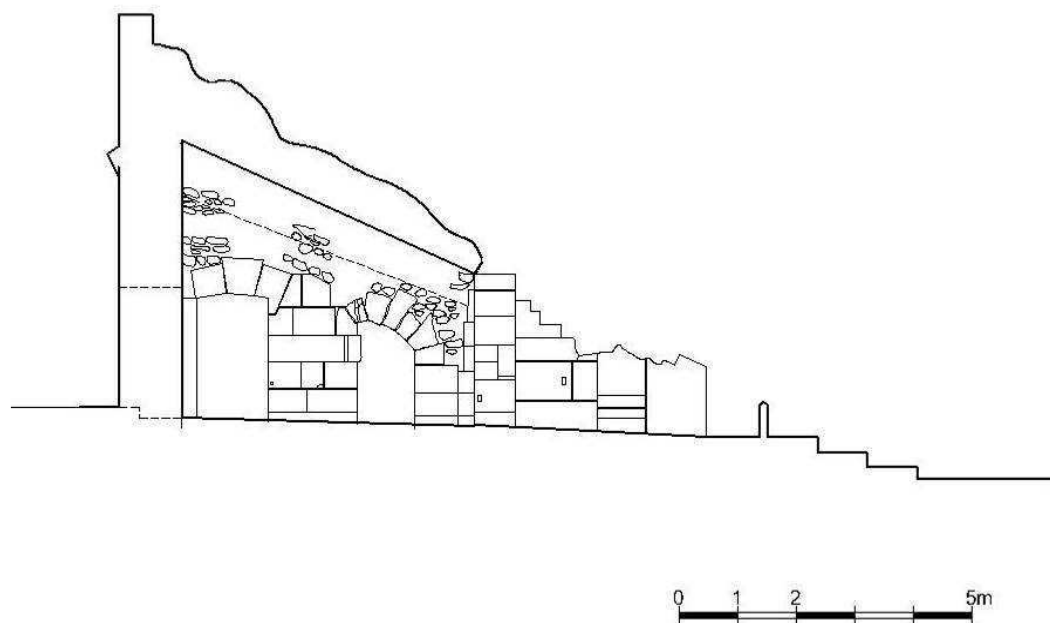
Façade latérale orientale de l'espace central sous la *cavea*.
